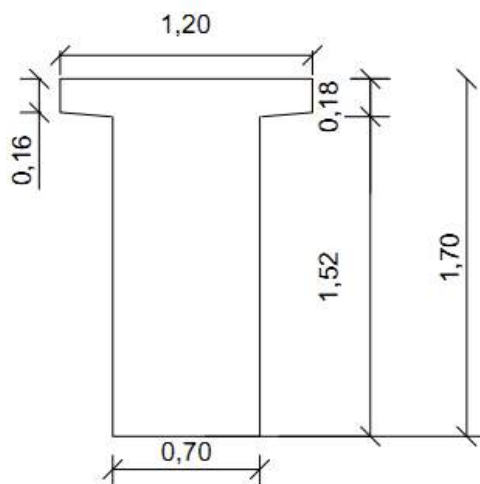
Seção transversal da longarina pré-moldada no apoio (medidas em m).
